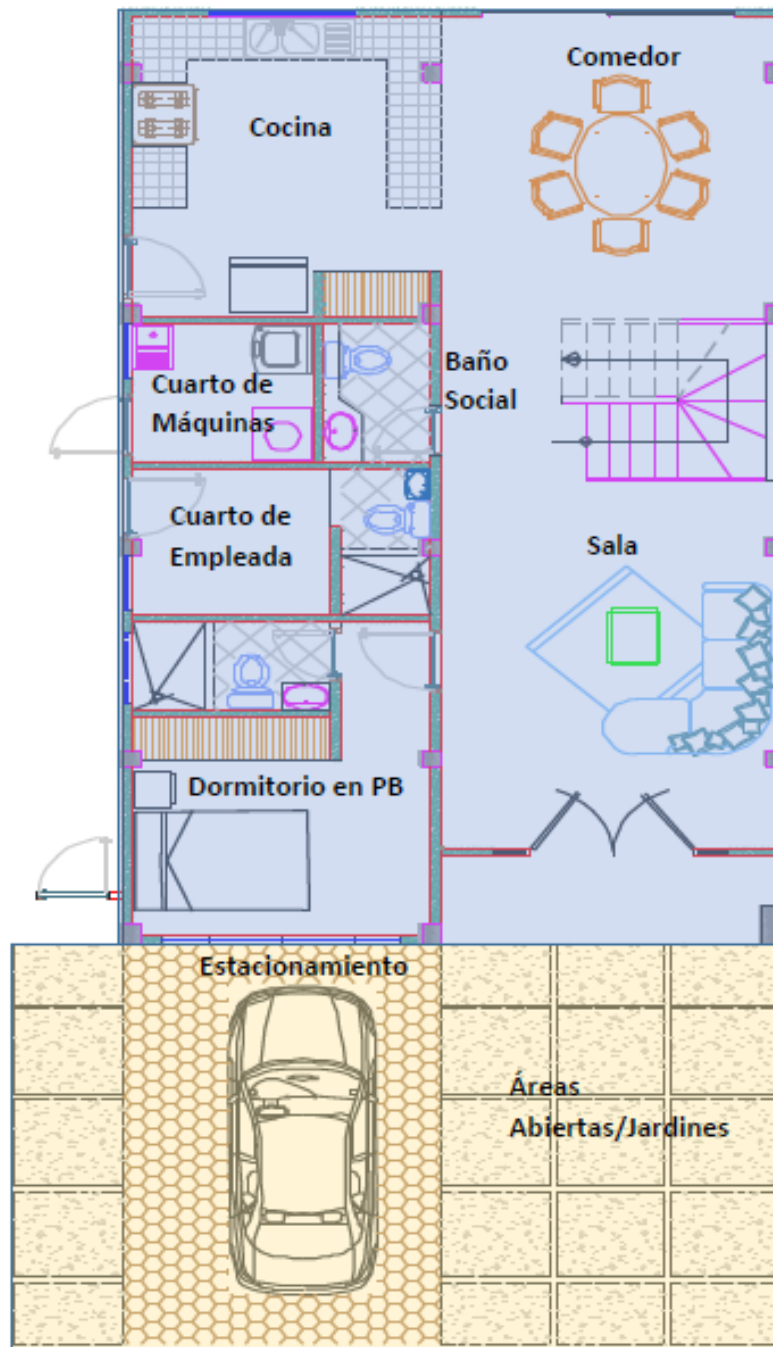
2 Planta Baja Vivienda Tipo No. 1
